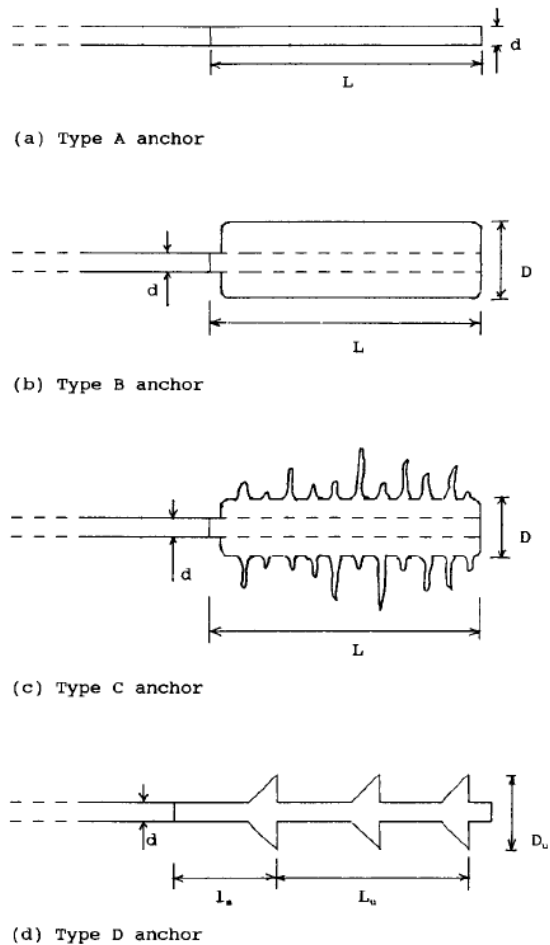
Tipos de anclas (Recuperada de Earth pressure and Earth retaining structures)
